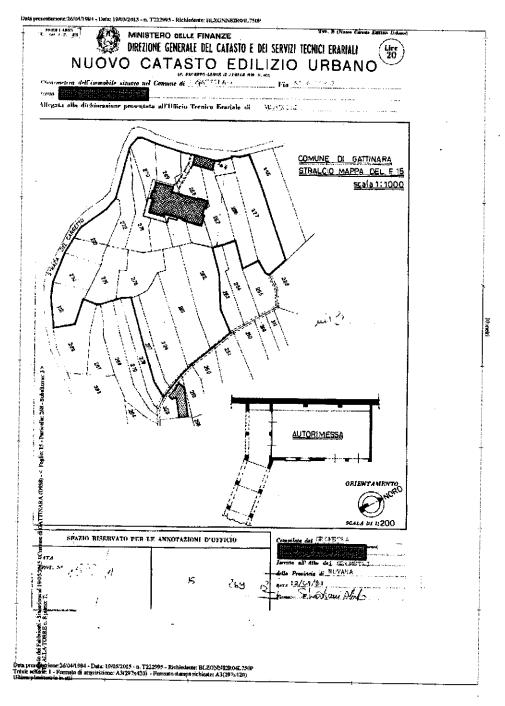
planimetria immobile 2, non conforme allo stato di fatto
